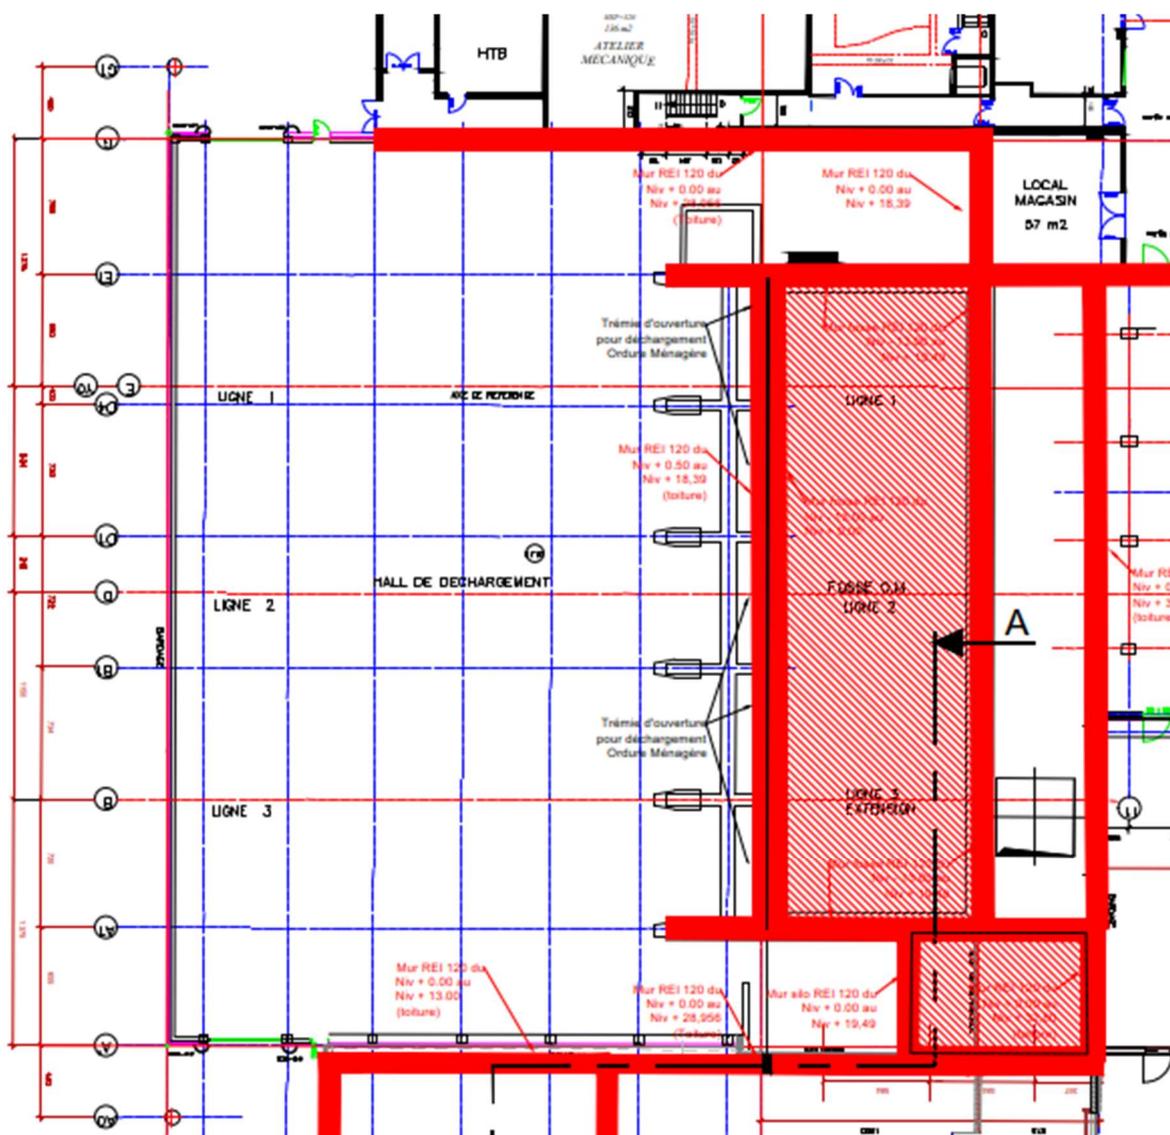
Vue en plan Mur coupe-feu entre fosse/silo HPCI et hall fours/chaudière
